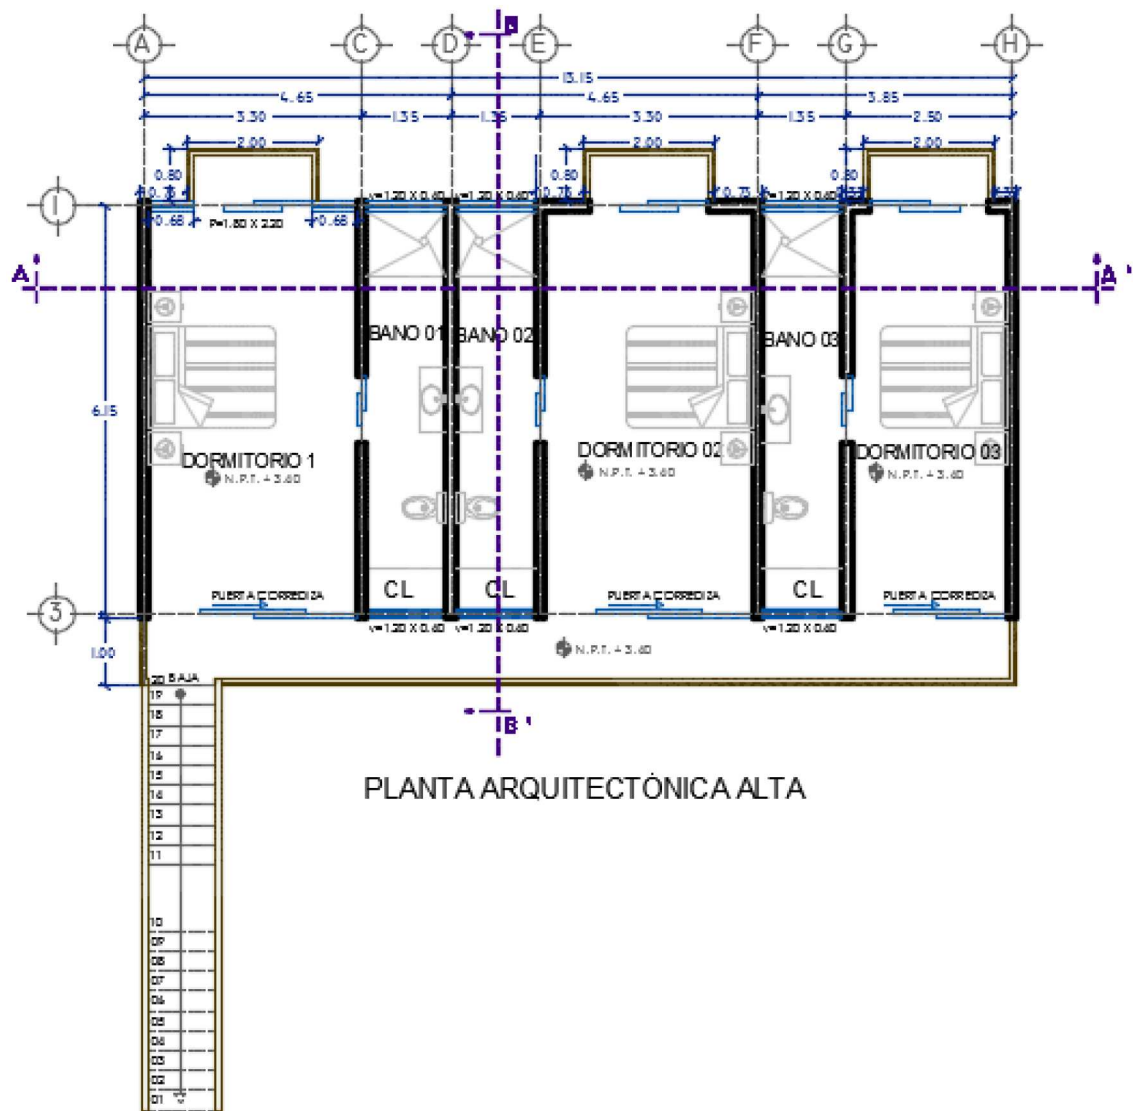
Planta alta. Casa de Veraneo (Retiros)
